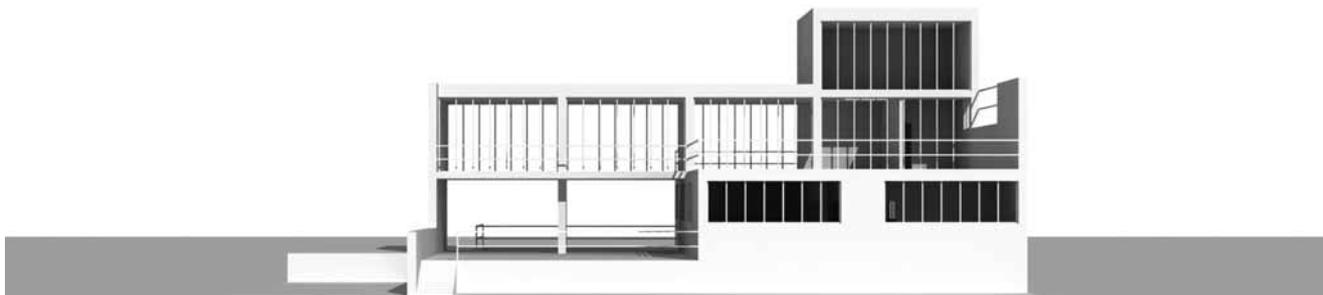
Progetto di casa *Wilinsky*, prospetto (disegno di M. R. Unterfrauner).
